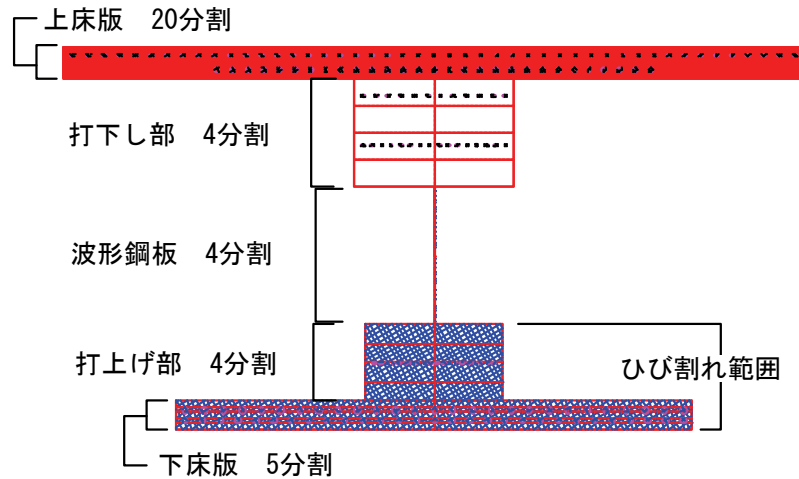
非線形解析におけるひび割れ範囲（実物大せん断実験供試体，1/4 点位置）
